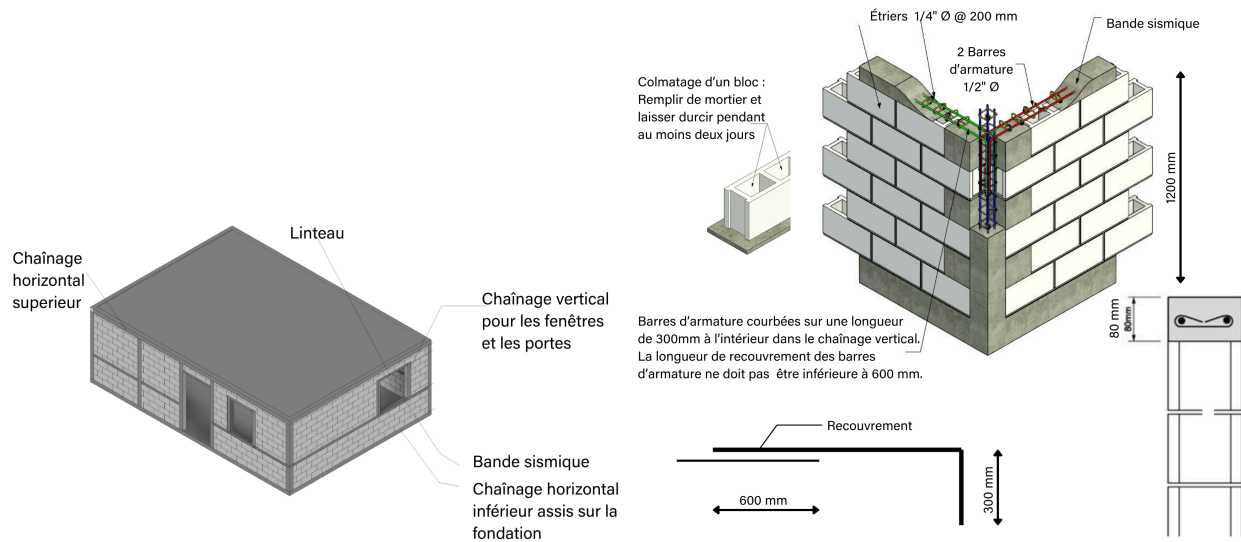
Détails de renforcement de poutre de liaison (libage)
